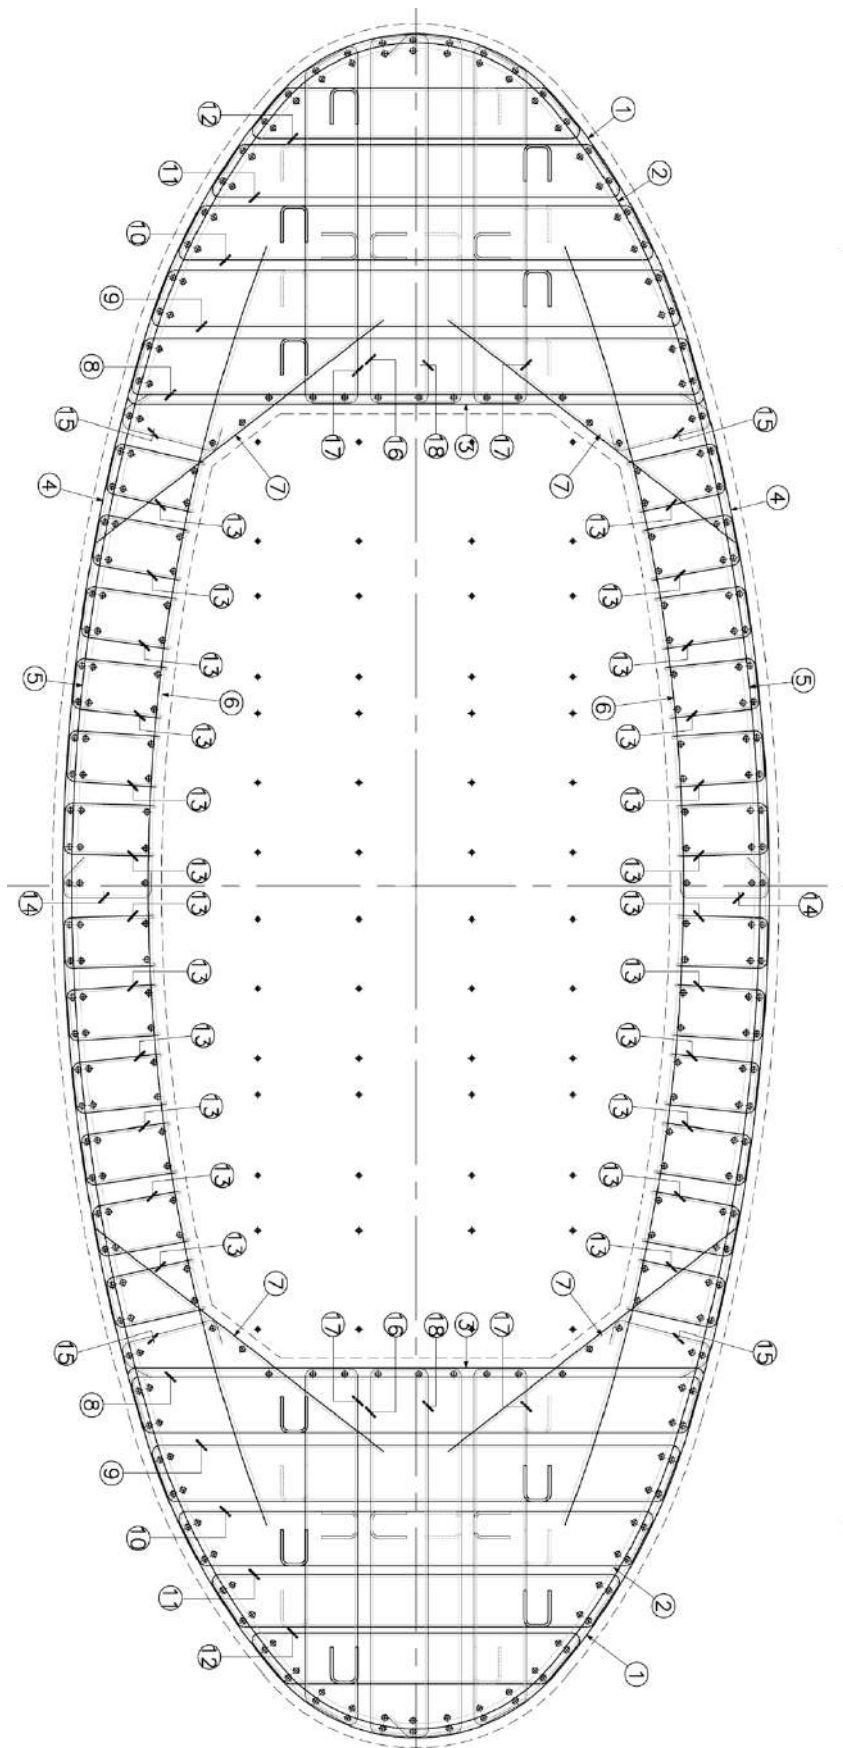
Armação do pilar da Ponte San Giorgio. Fonte: We Build
